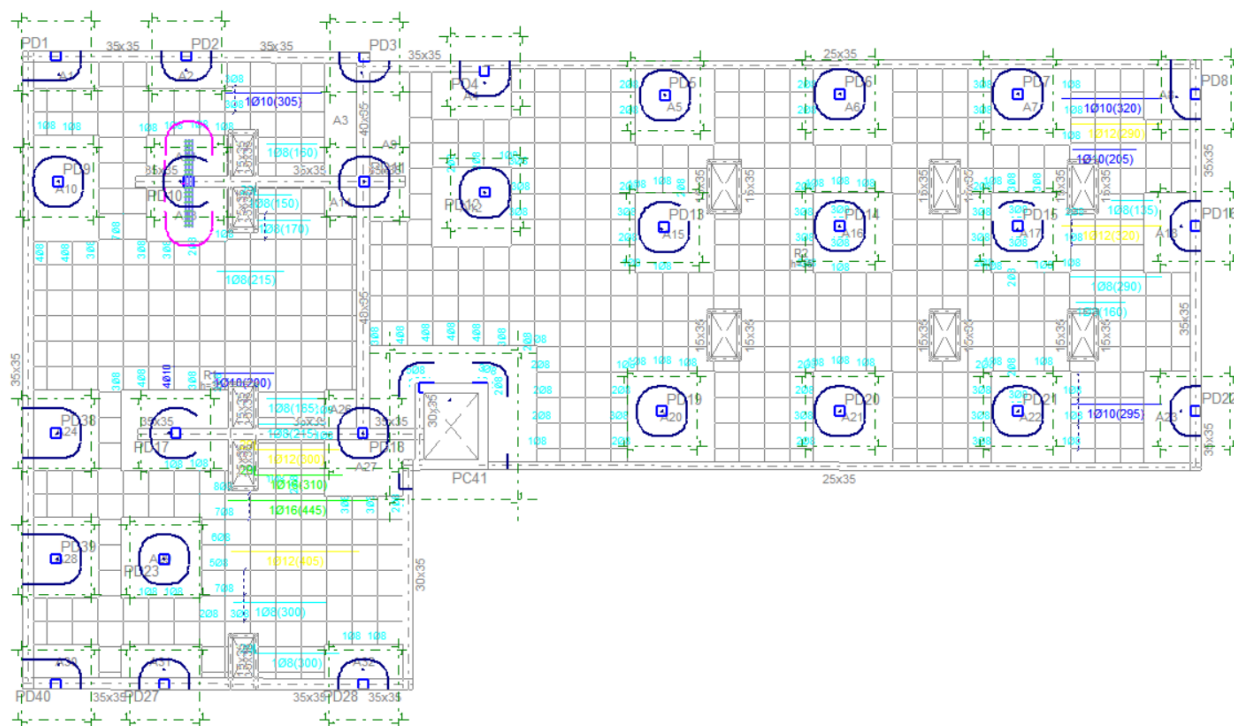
Punzonamiento Planta Cubierta, Módulo D
